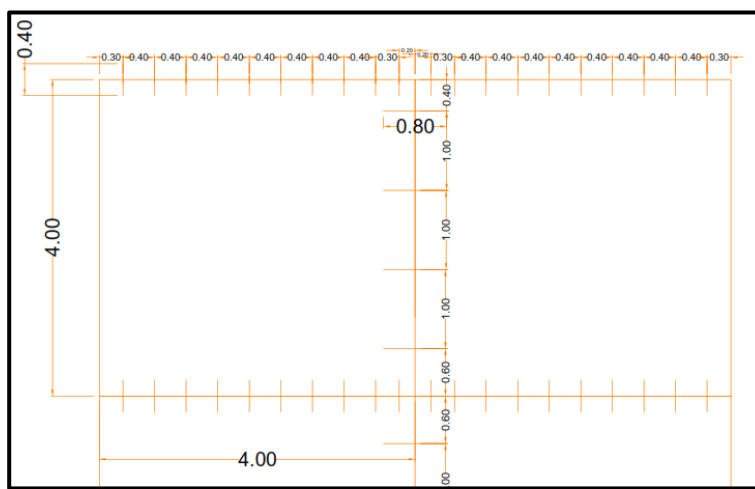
Detalle distribución dovelas de transferencia en juntas, fuente: propia autocad
